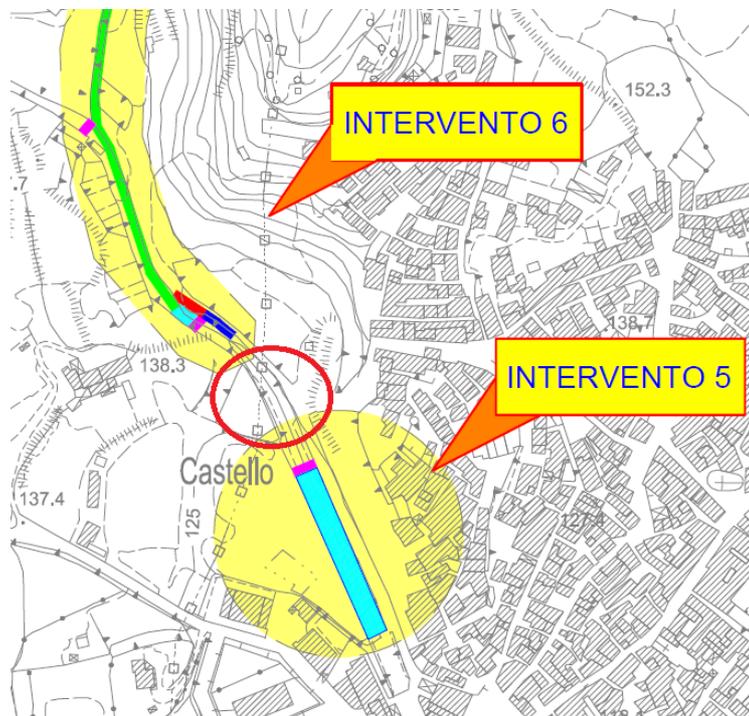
Area oggetto di ripristino delle pavimentazioni
